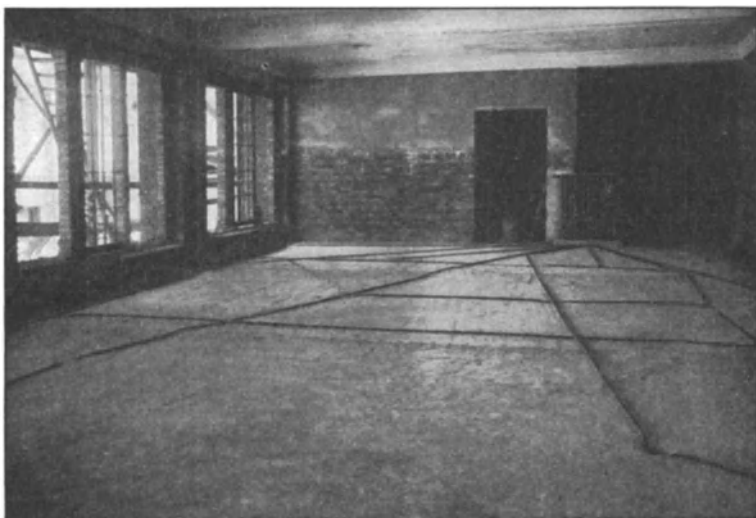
Über der Betondecke verlegte Stahlpanzerrohre.
